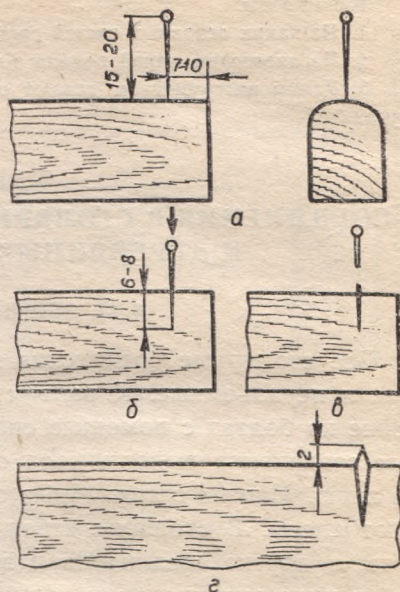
Установка гвоздиков в брусочки рейсмуса:
